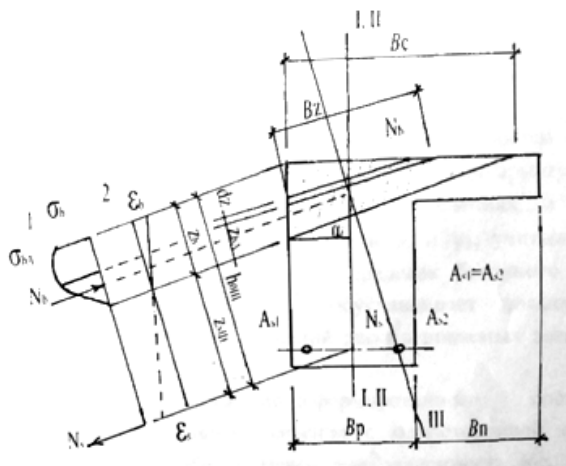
Напряженно-деформированное состояние железобетонной балки прямоугольного сечения с односторонней сжатой полкой: 1 – схема внутренних усилий; 2 – диаграмма деформаций
